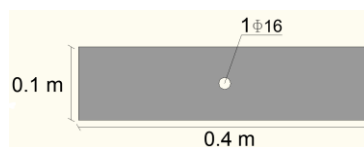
Sección del refuerzo de hormigón en la mampostería (diámetro de la barra de acero en milímetros)
